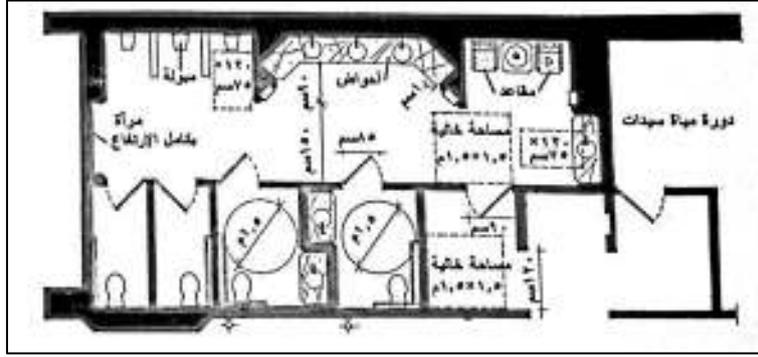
مسقط أفقي لمدخل دورة مياه عامه
